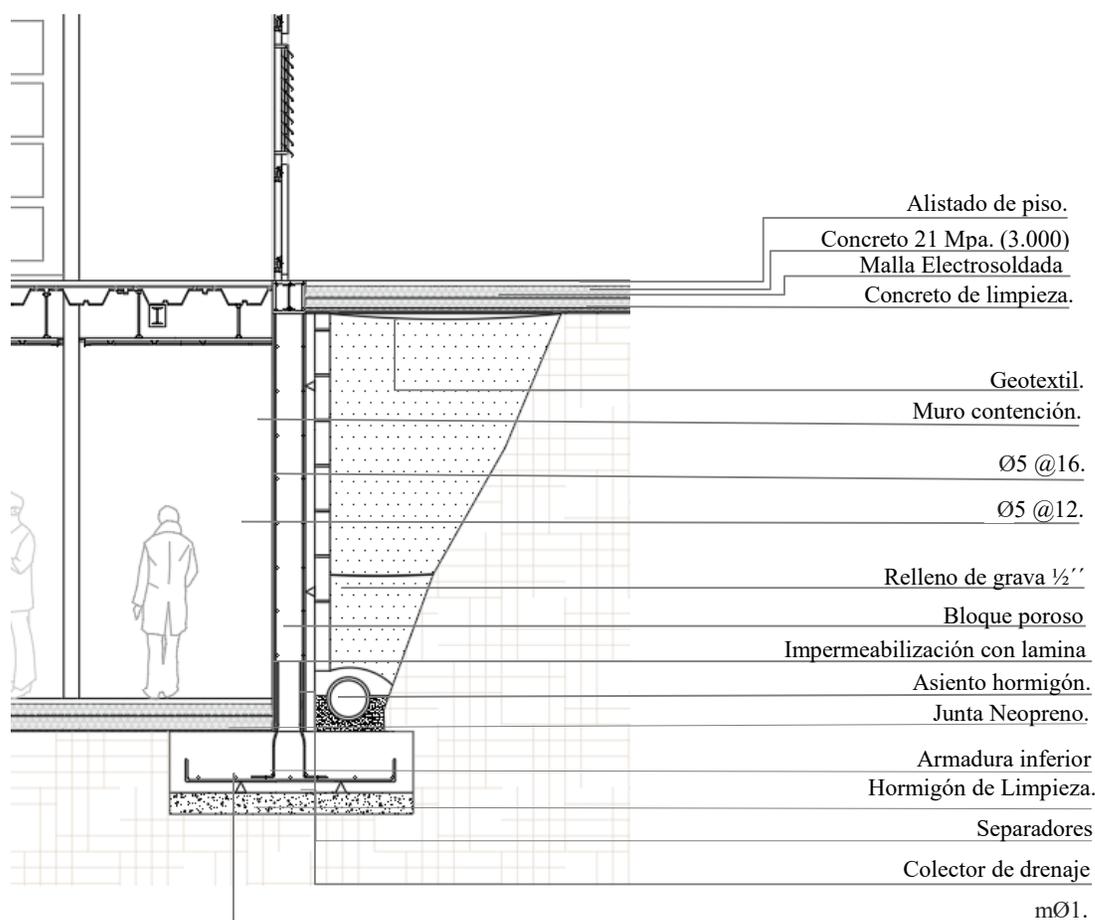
Detalle constructivo corte sótano/fachada. /Fuente: Elaboracion propia.
